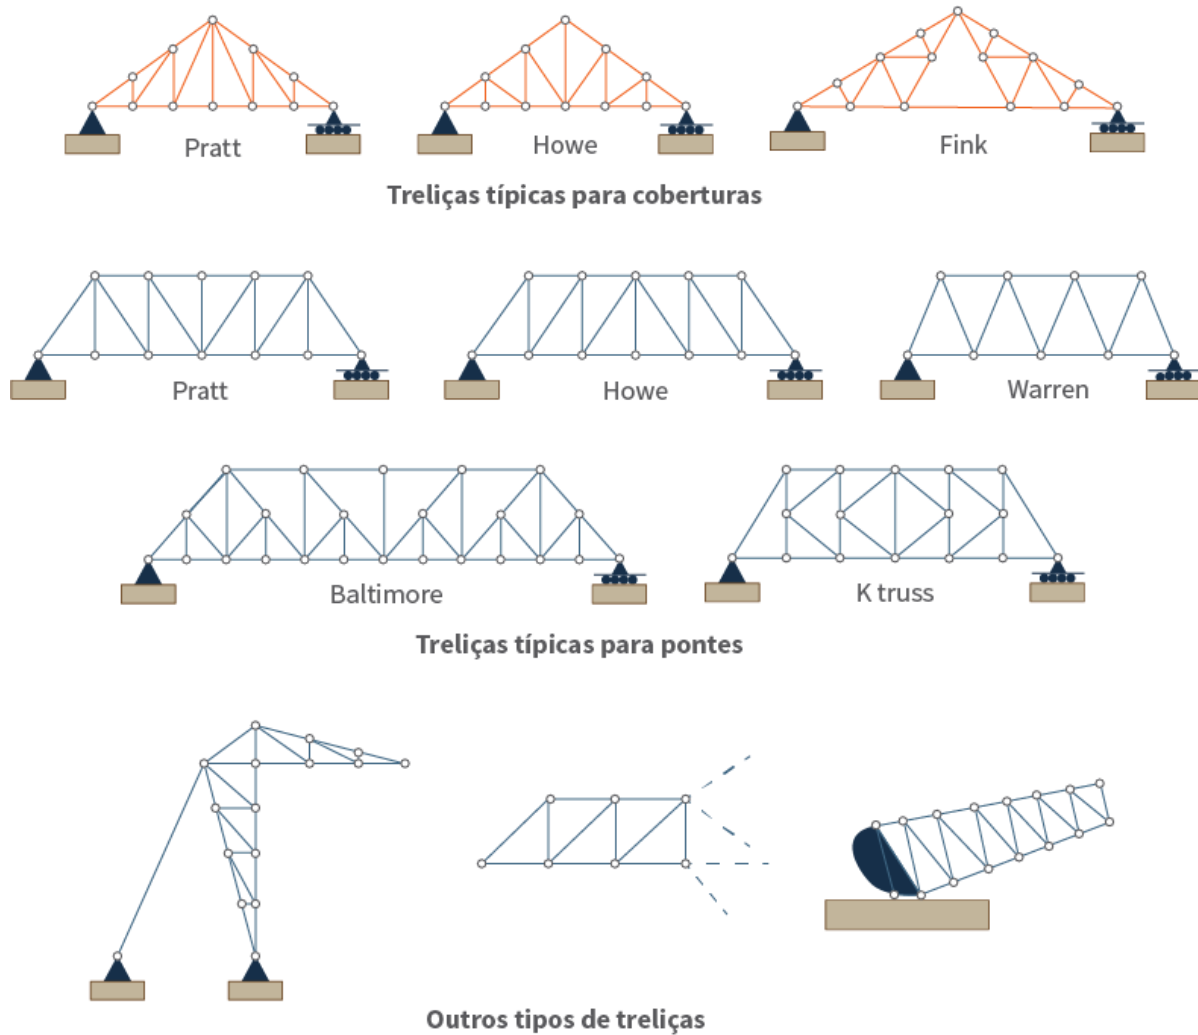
Tipos de treliças mais comuns encontradas no desenvolvimento de coberturas, pontes e outras construções.
